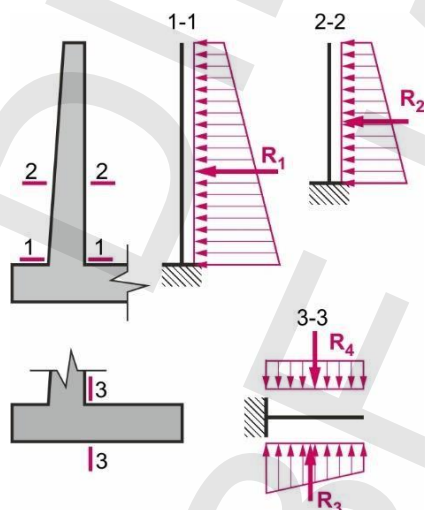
Schemele statice pentru determinarea momentelor încovoietoare și a forțelor tăietoare
